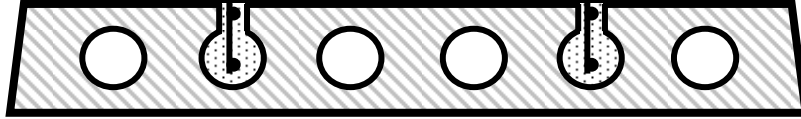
Підсилення залізобетонних плит нарощуванням каркаса по нахильному перетину
